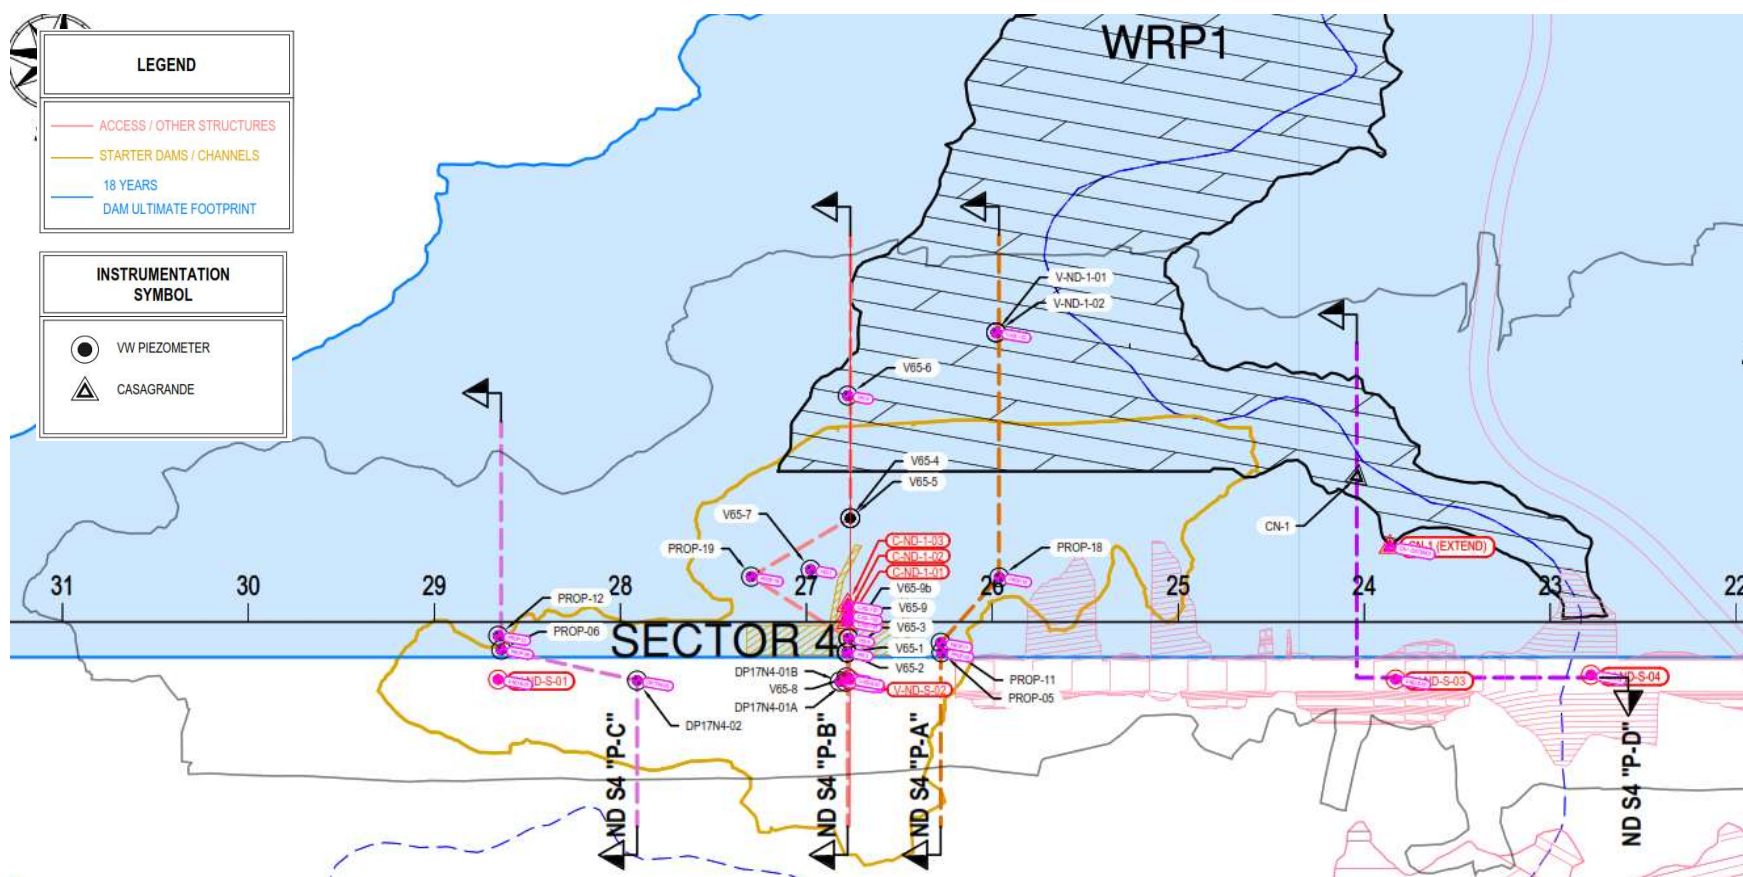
1: Vista en planta del sector 4 de ND - Grupos de instrumentos Piezometro y Casagrande
